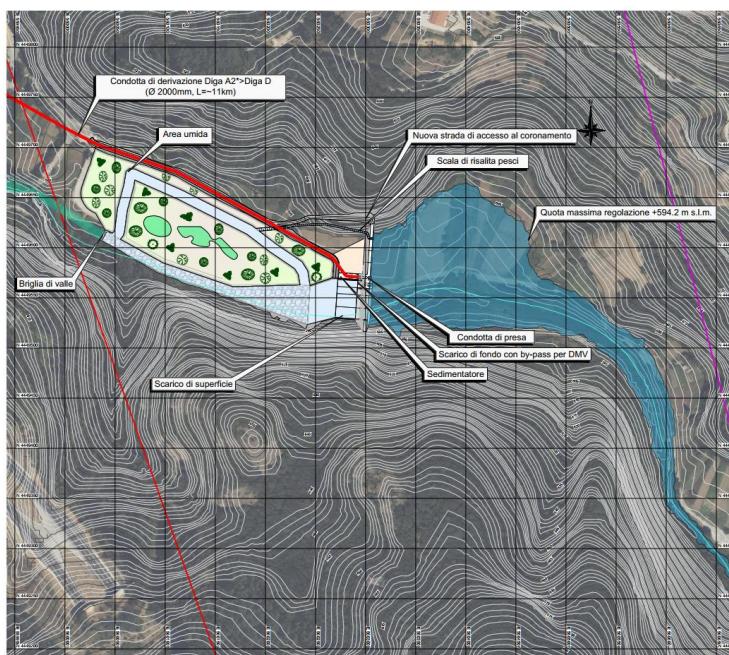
Alternativa 3 (A2*+D), Diga A2*, planimetria della diga e dell'invaso (estratto da [29])
